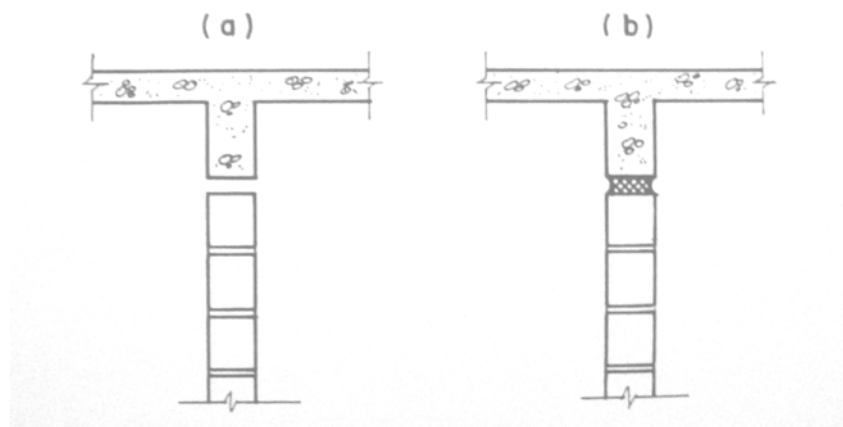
Desvinculação entre a parede fissurada e o componente superior
